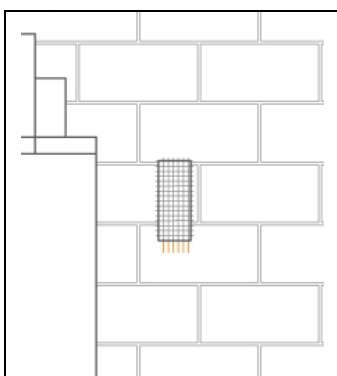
Detalle manchas de óxido. Verja ventana fachada Sur (1)
